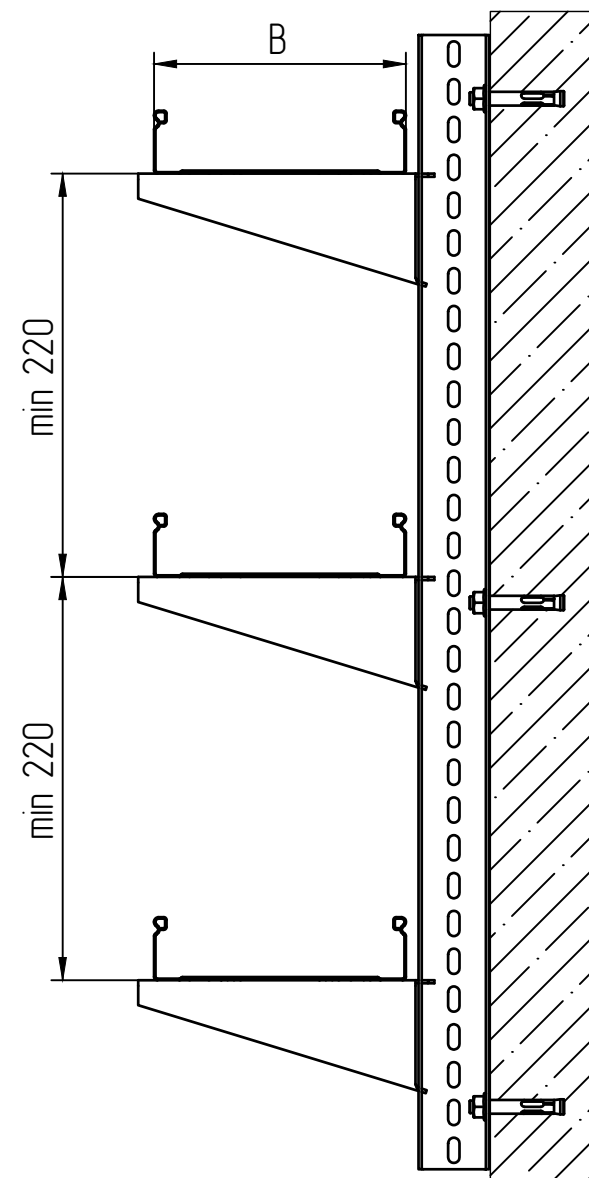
Крепление П-образного профиля к бетонной стене на док
